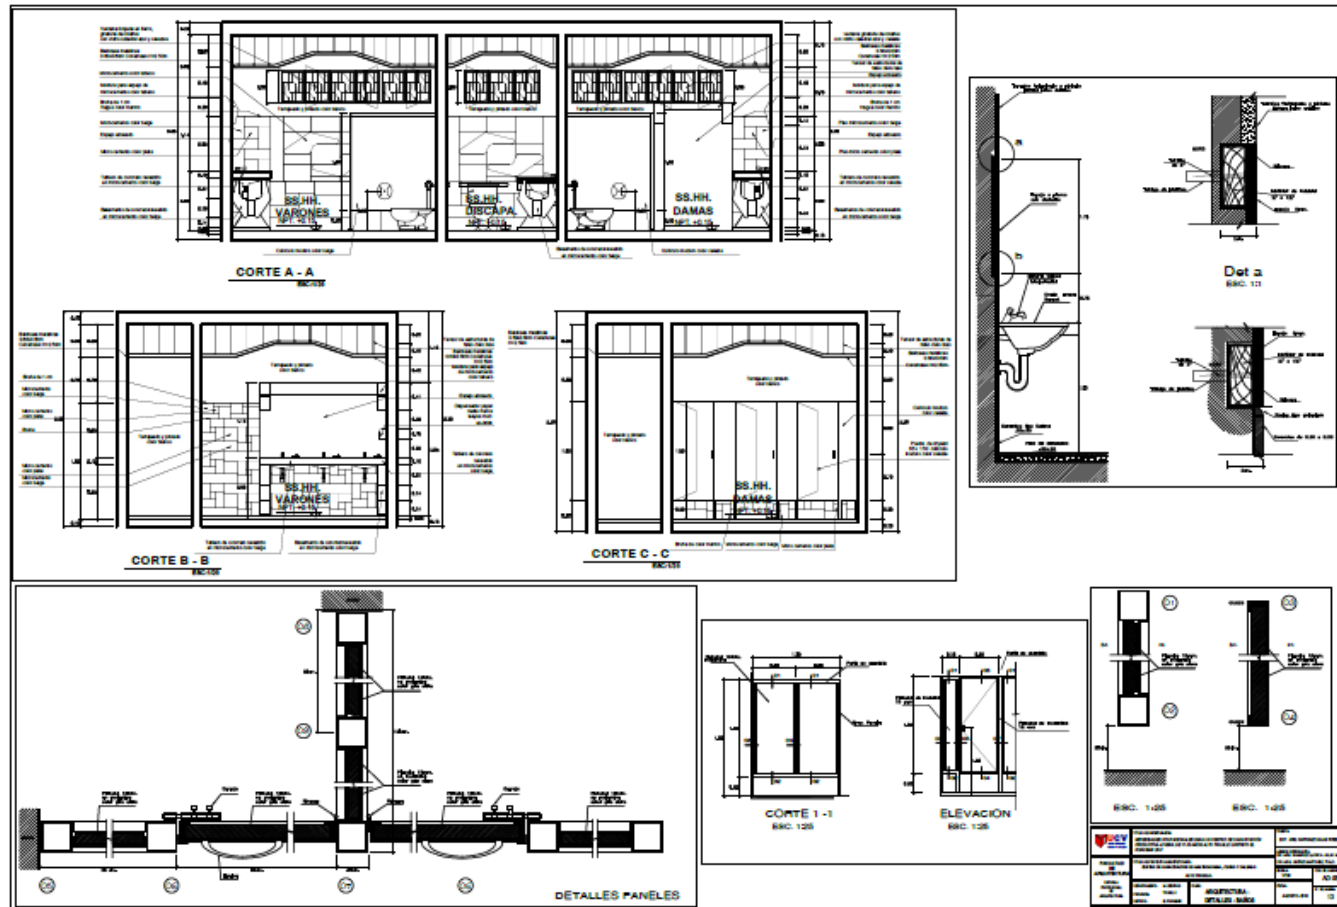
Plano de Detalle Arquitectónico, Cortes, detalles de vanos y grifería de baños -Plano N°13-Lámina AD05
